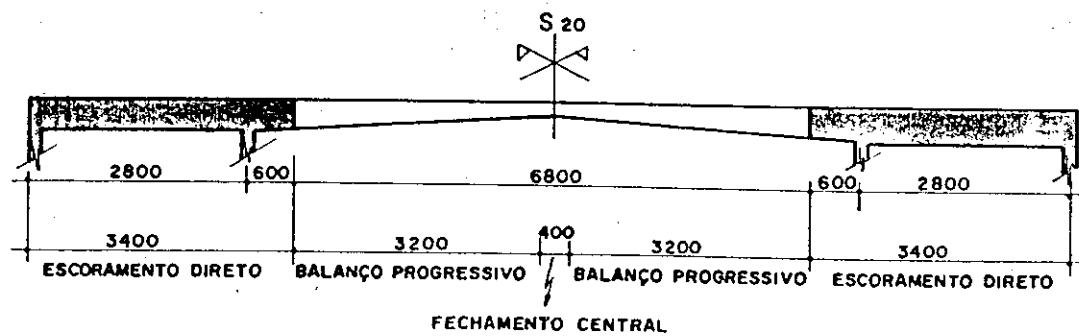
VISTA LONGITUDINAL - (cotas em cm)
